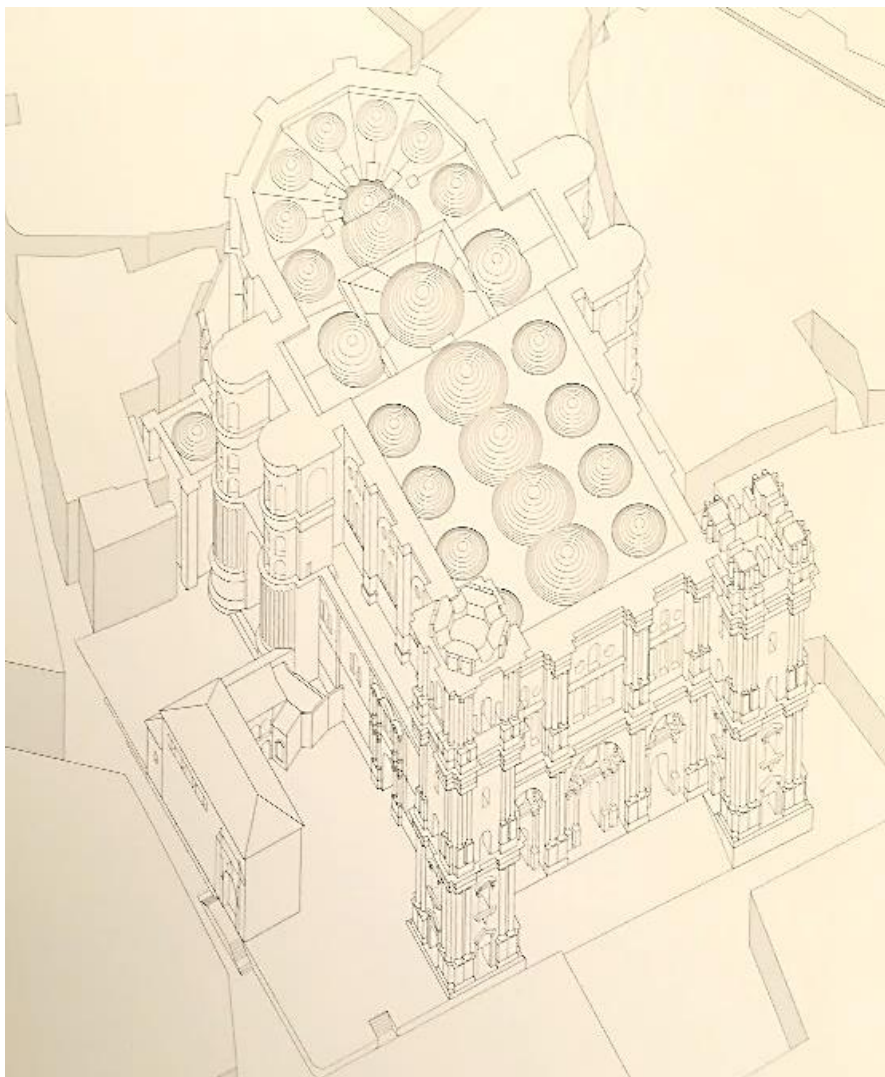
Maqueta del aspecto externo de la catedral tras las obras finalizadas en 1768 (unión de la nave con el cruceiro)²⁵⁹.
